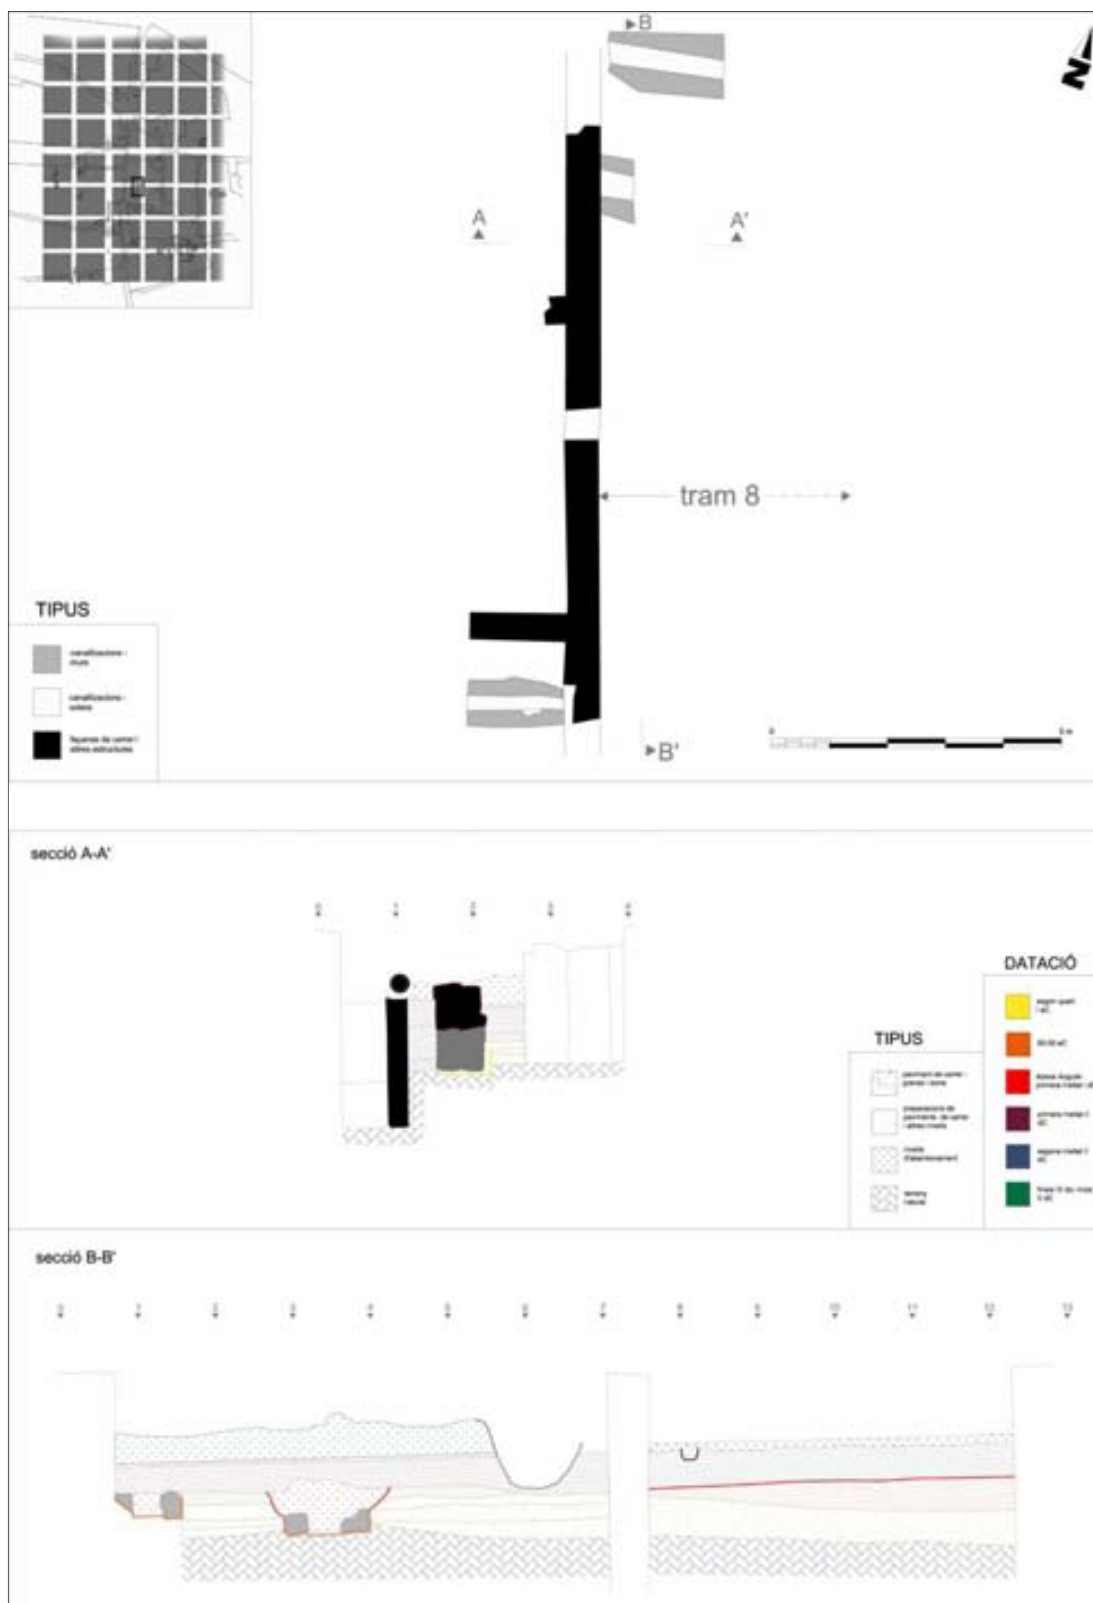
Planta i seccions del tram de carrer 8 d'Iluro, excavat el 2000-2001 (adaptat de Muñoz 2003)
